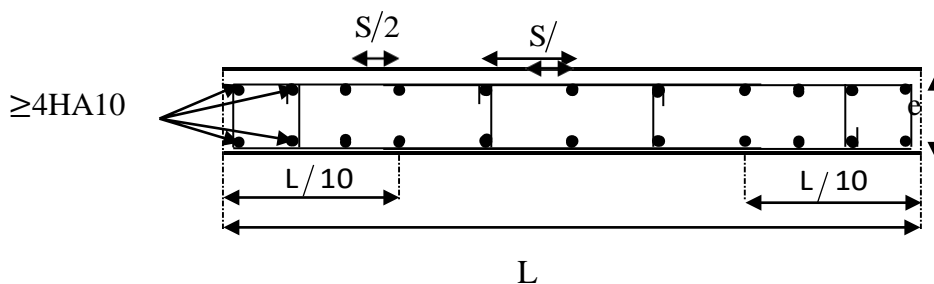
Disposition des armatures verticales dans les voiles.
